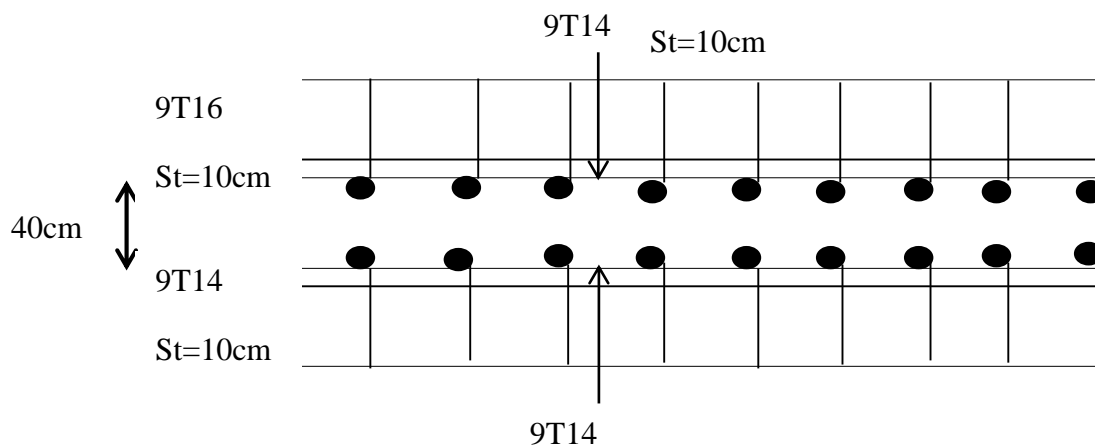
Ferrailage de la dalle du radier pour une bande de 1m
